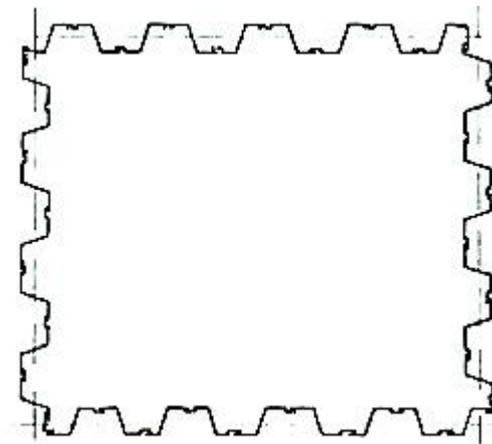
Grundriss einer Spundwandbaugrube[13]
